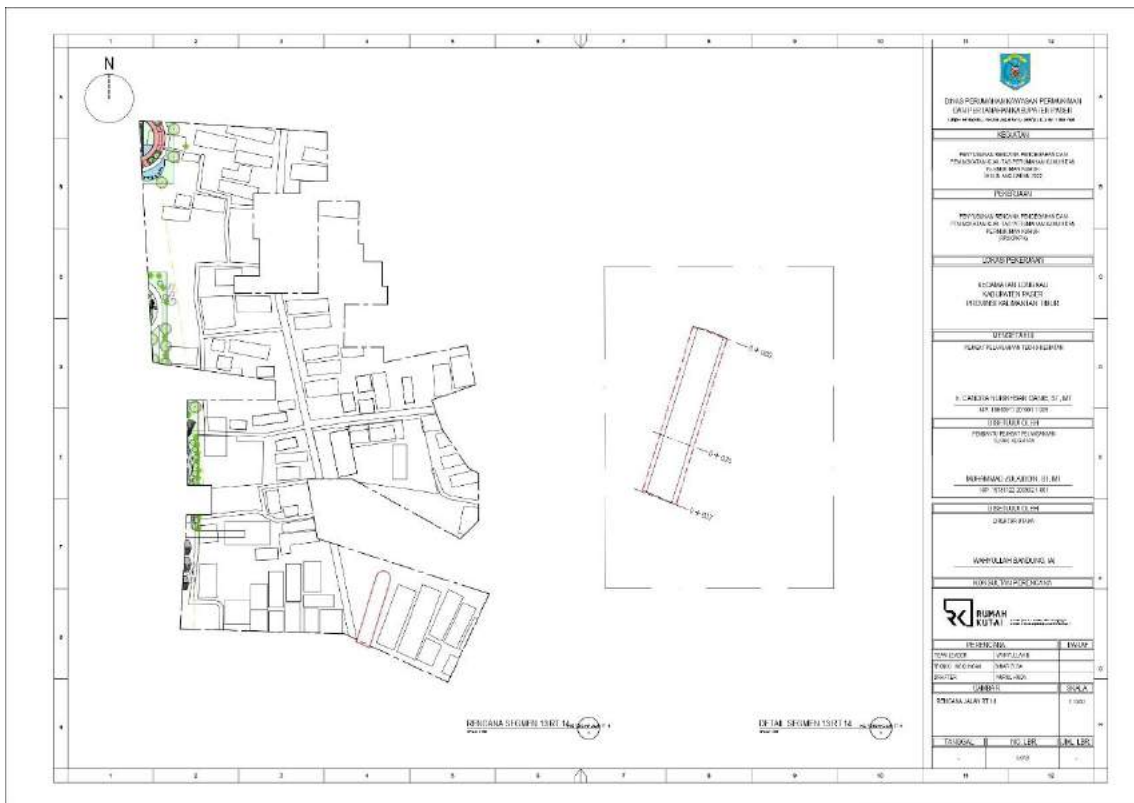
90 Konsep Recana Jalan Segmen 8 RT.14
